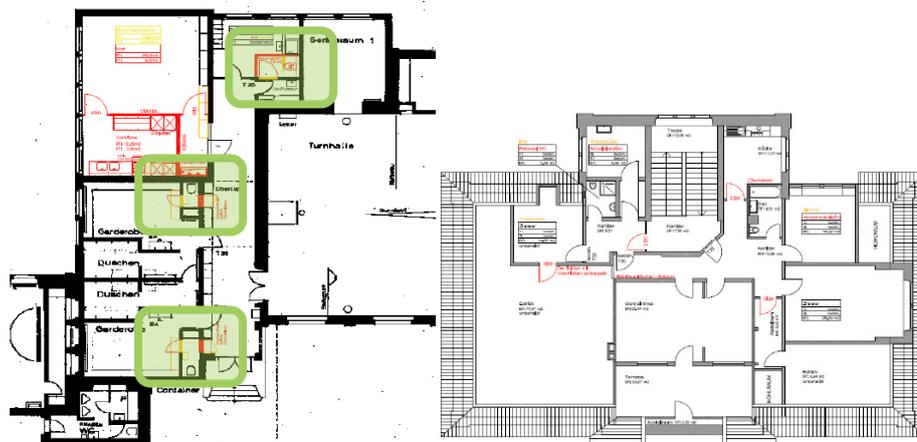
Grundrisse Hort Mühlebach (Zürich)
